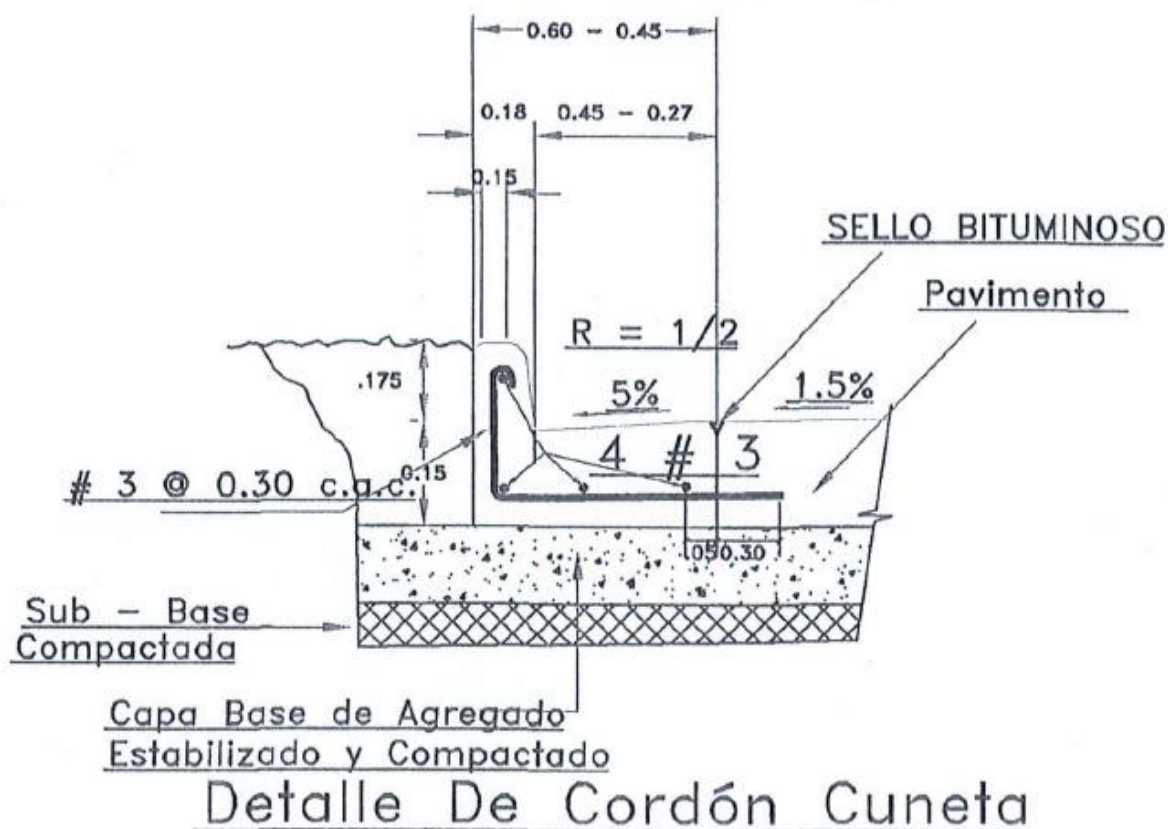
Detalle de acera del proyecto. Fuente: Plano de anteproyecto.
